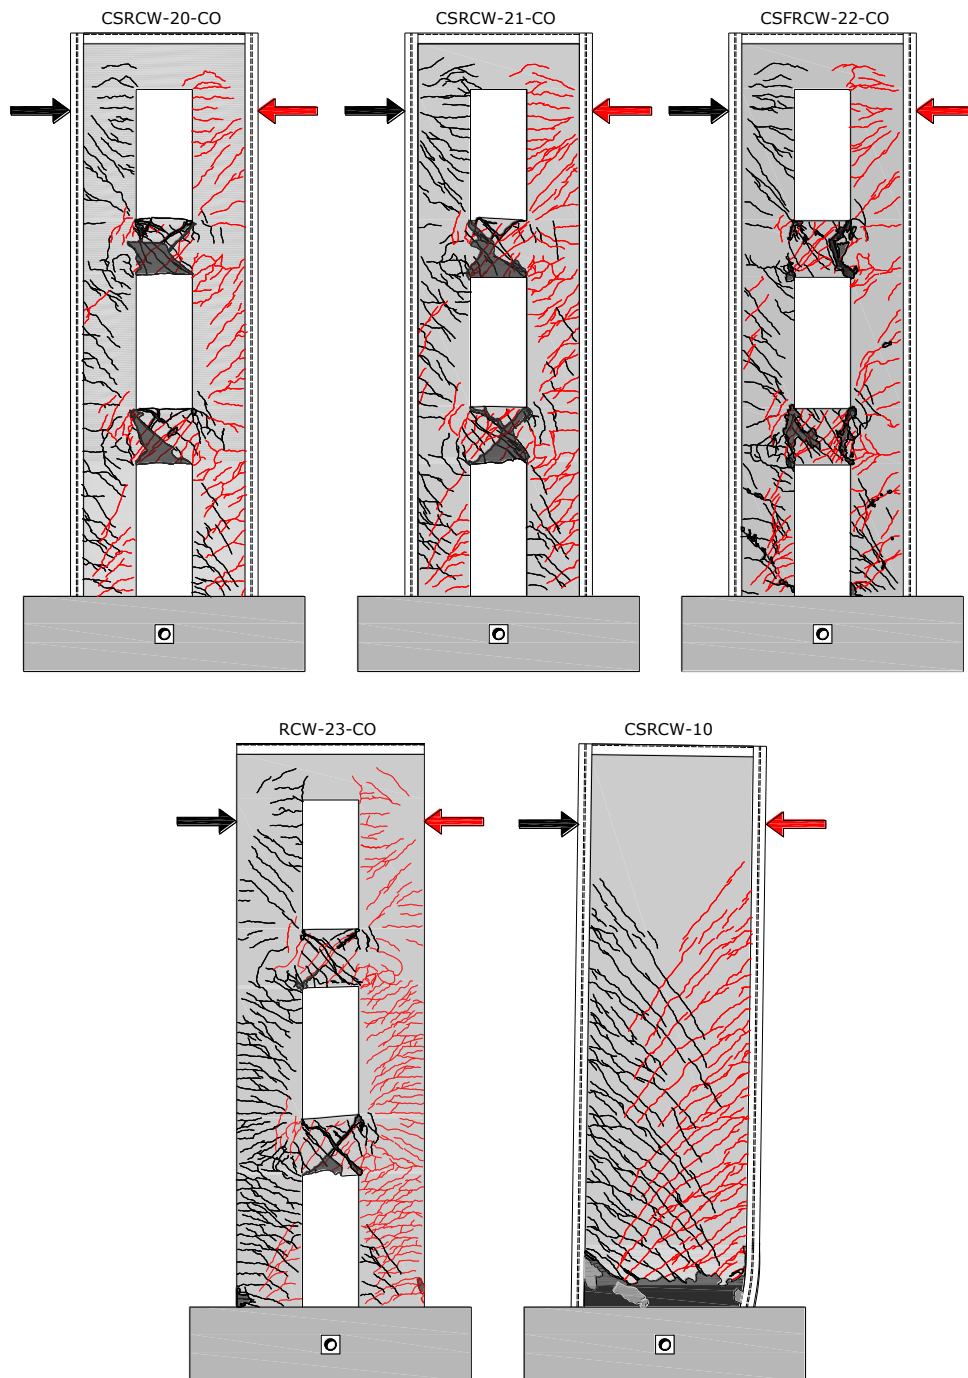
Starea de fisurare în momentul cedării elementelor
